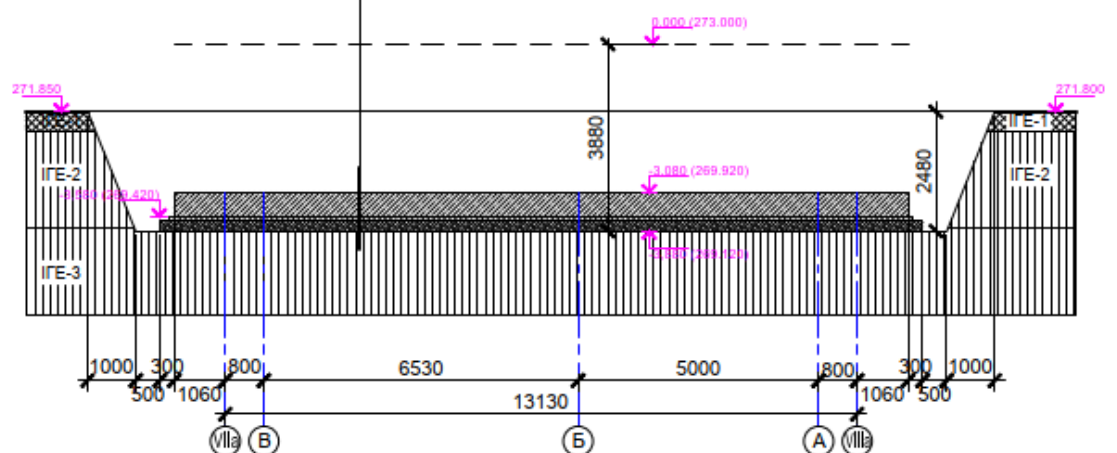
Конструкція фундаментної плити у котловані
